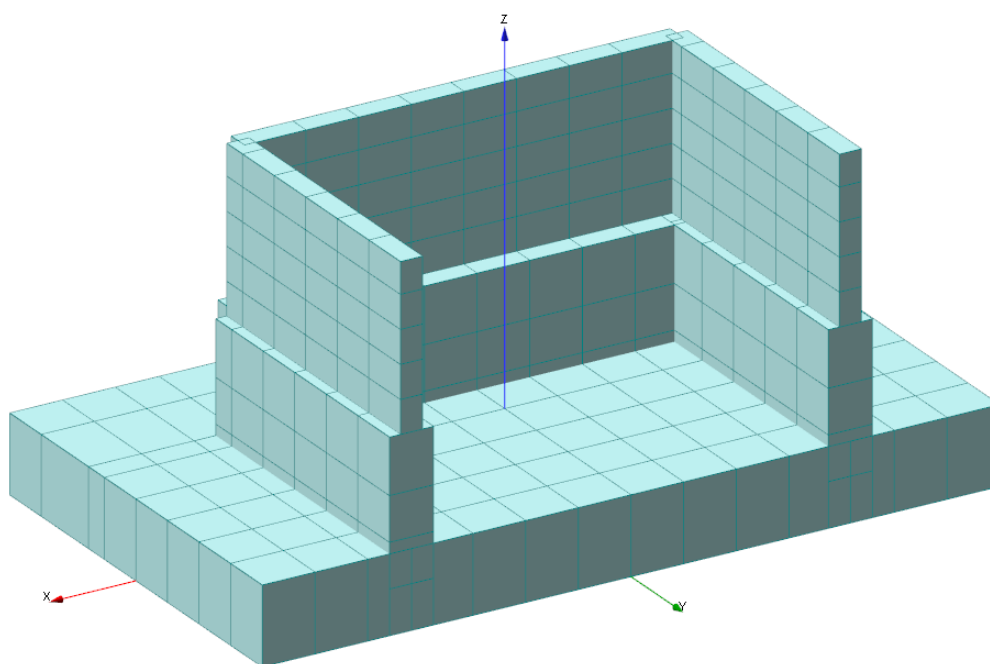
VISTA TRIDIMENSIONALE SPALLA 2 - ASSI DI RIFERIMENTO
